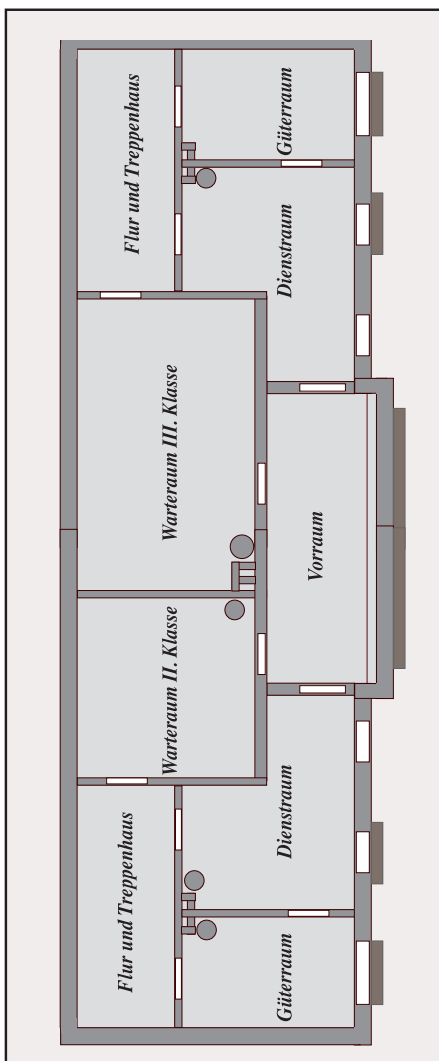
EG Eisfelder Talmühle, Grundriss
